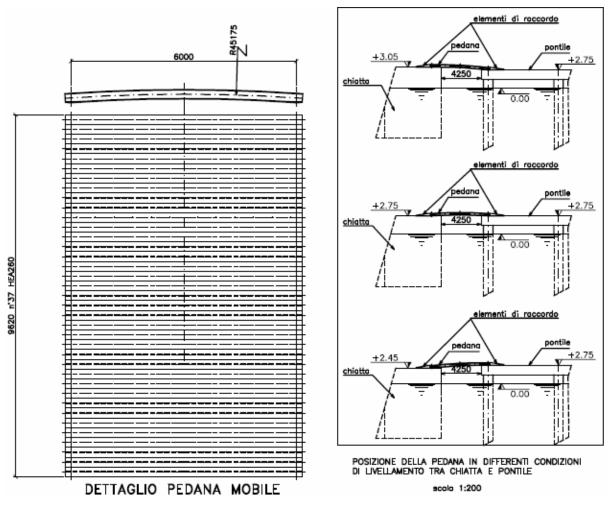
dettagli del collegamento tra chiatta e pontile d'attracco
